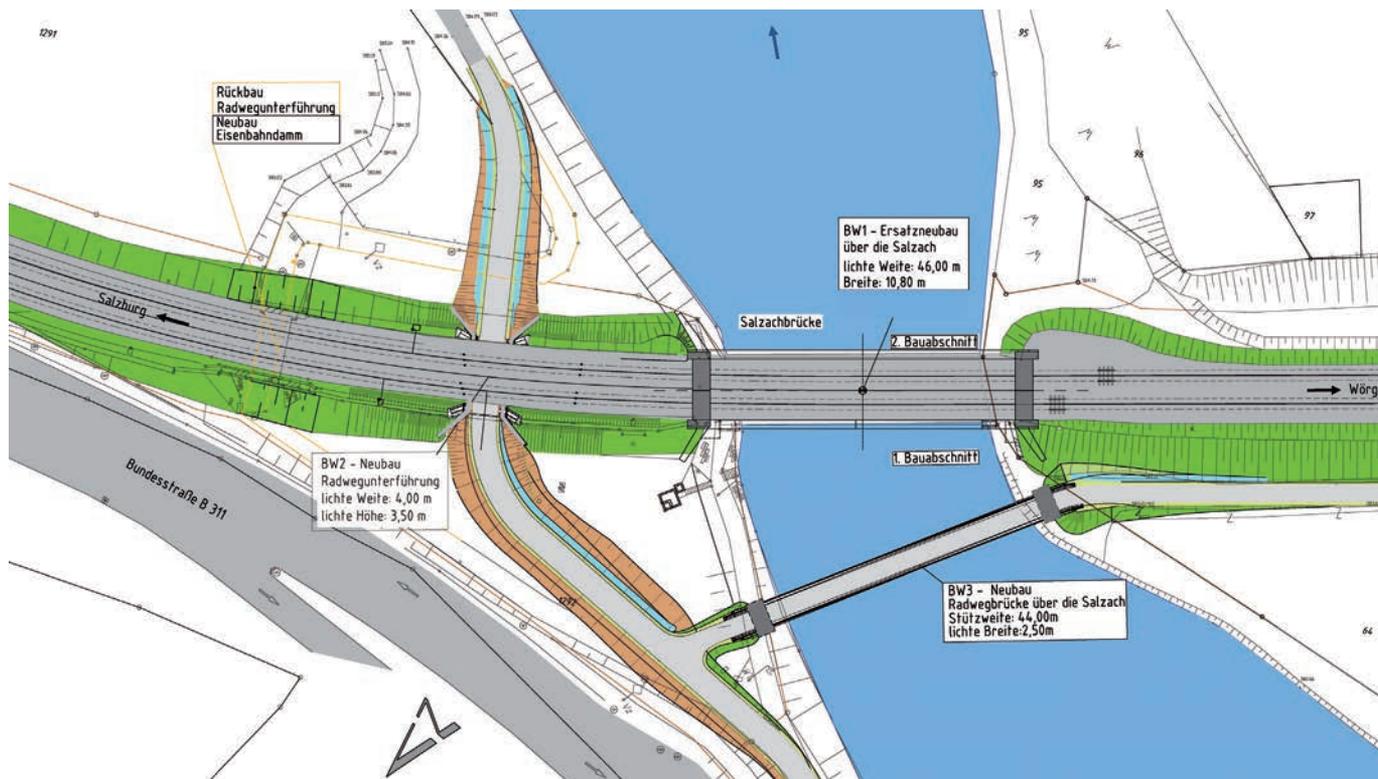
Lageplan der neuen Salzachbrücken mit Bahnbauwerk und Fuß- und Radwegbrücke (© SSF Ingenieure)
